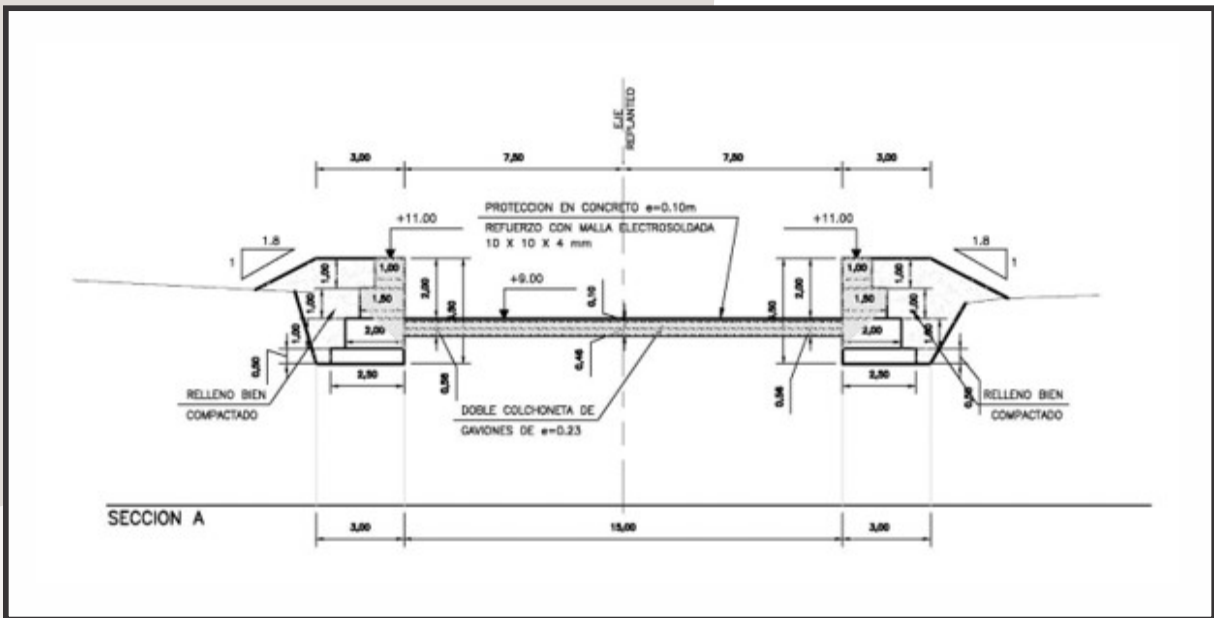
Canalización del río San Juan - obra de entrada – sección transversal
